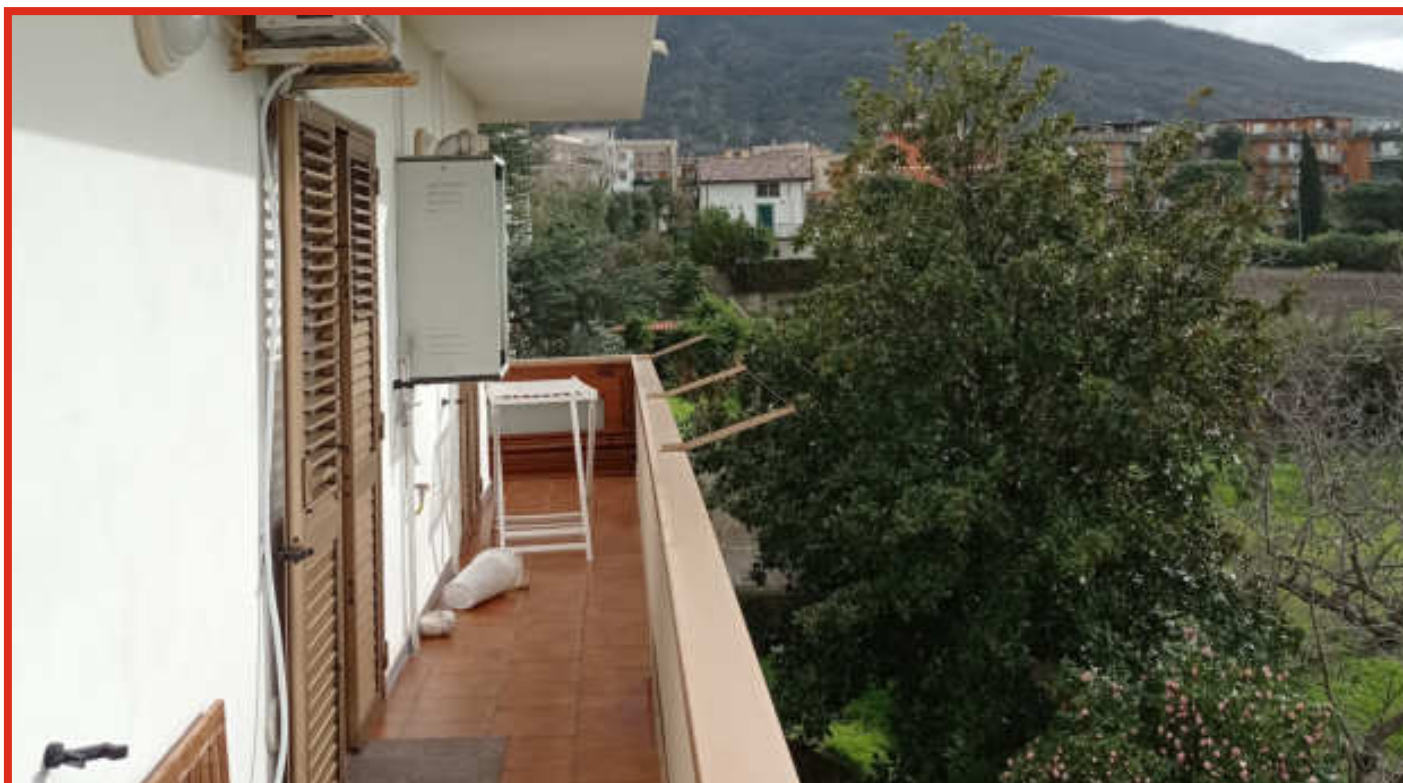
Vista interno balcone appartamento piano 2°, int. n.9
